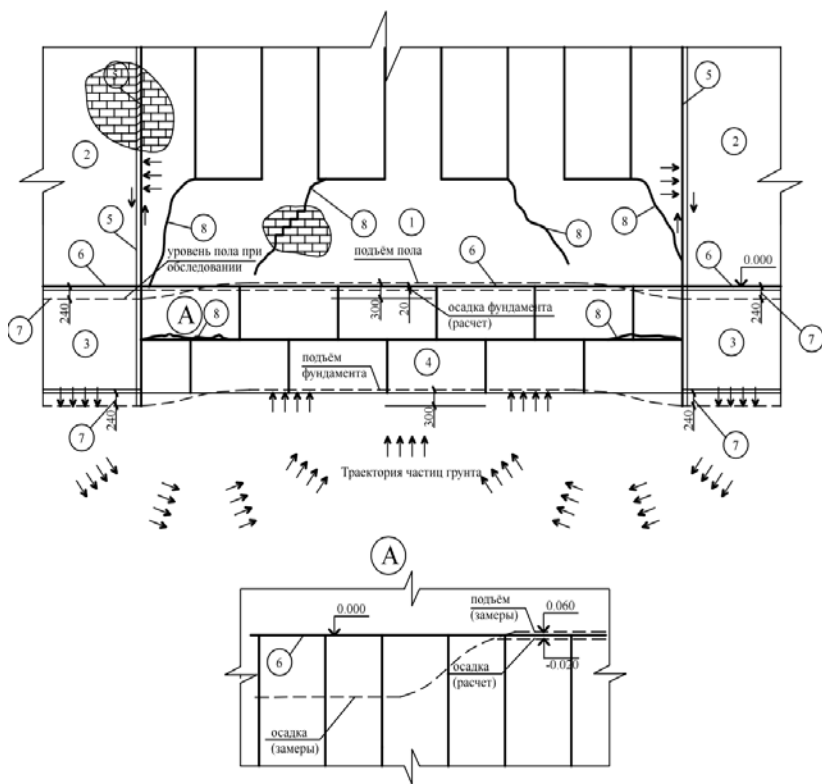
Влияние фундаментных плит на ленточные фундаменты:
